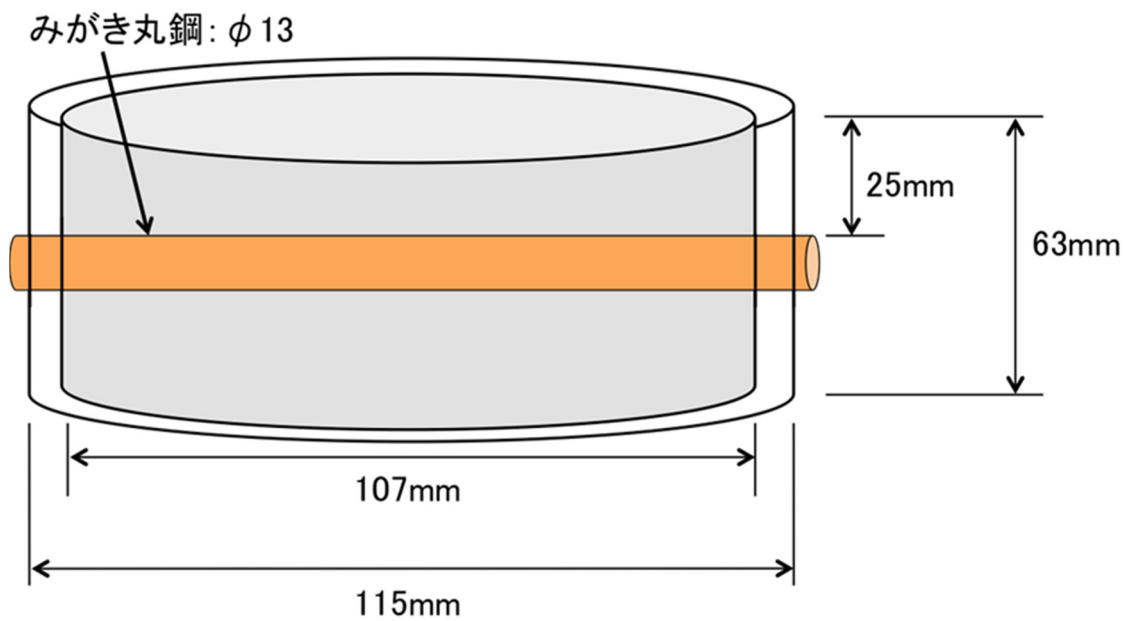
予めひび割れを入れたコンクリート供試体の概略図
